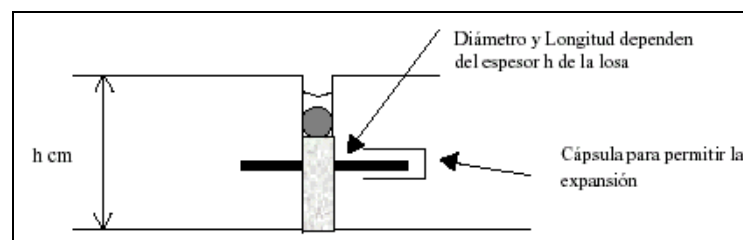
Juntas de Expansión para Losas del Pavimento Rígido
